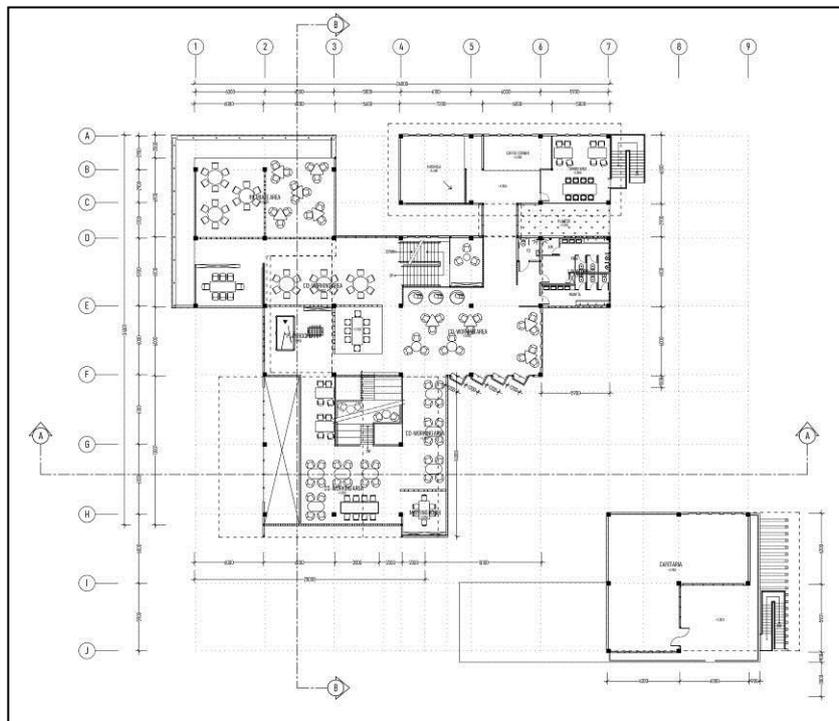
menyajikan denah lantai dasar. Gambar denah lantai dasar menggambarkan susunan ruang lantai dasar yang terdiri dari zona publik (*lobby, waiting area, reception desk, multipurpose hall, amphitheater*), zona semi publik (*workspace, meeting room, quiet room, printing corner, working courtyard*), zona semi privat (ruang inkubator), dan zona servis (*lavatory, janitor, pantry, gudang, dining area, ruang mee*). Ruang pada denah setiap lantai dikelompokkan juga berdasarkan konsep utama pada perancangan ini yaitu *creative space* yang terdiri dari *space for stimulate, collaborate, reflect, dan play*. Terdapat ruang hijau sebagai *view* dari dalam keluar ataupun ruang hijau didalam bangunan, tersapat ruang kerja yang didesain dengan konsep *open plan* atau ruang-ruang terbuka dengan pembatas ruang berupa partisi ataupun level lantai, ruang bersama yang dapat mengakomodasi kegiatan lain selain bekerja, kemudian untuk ruang sendiri atau *quiet room* yang hanya dapat mengakomodasi 1-2 orang. Terakhir ruang yang merupakan ruang untuk bermain atau ruang refleksi.
